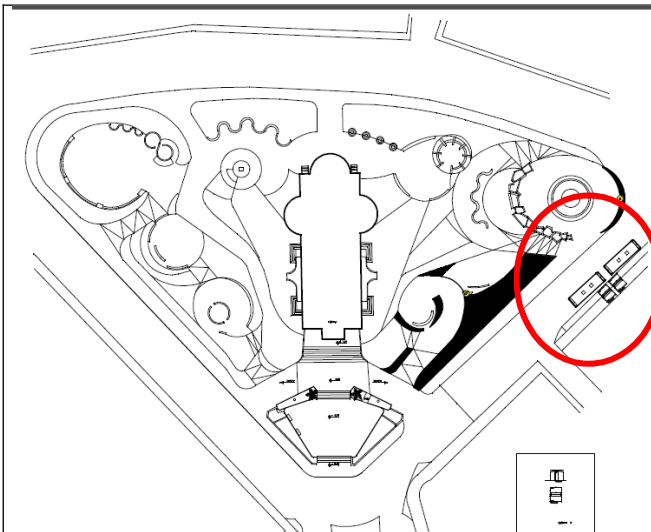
Vista da Praça com a intervenção proposta em destaque.
